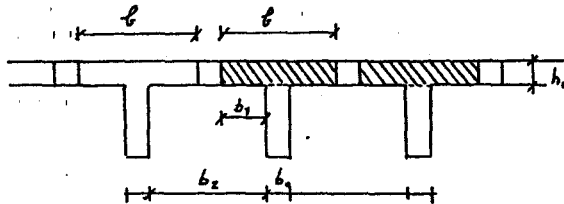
a. Largeur de calcul d'une poutre en T
